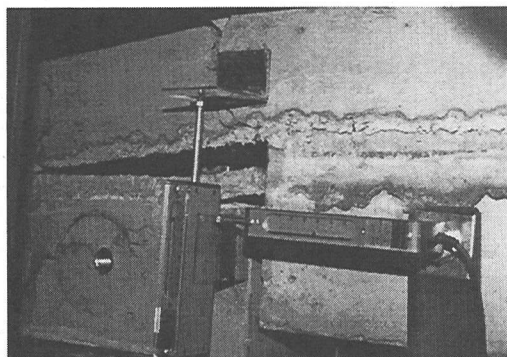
岩塊崩落模擬実験におけるひび割れ発生状況
